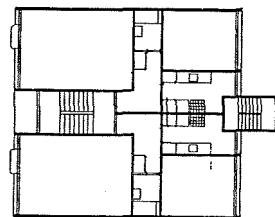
Plan af Lejlighed i et Betonhus. Maal 1:400.
